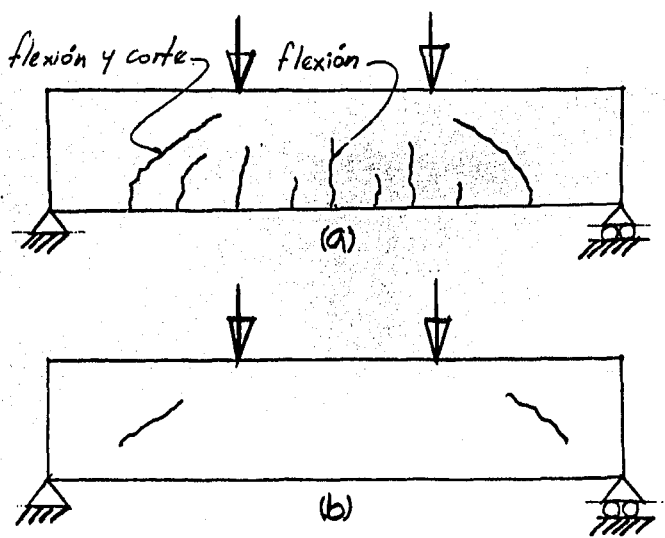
Tipos de grietas inclinadas. (a) Grietas por flexión cortante. (b) Grietas por cortante en el alma.
